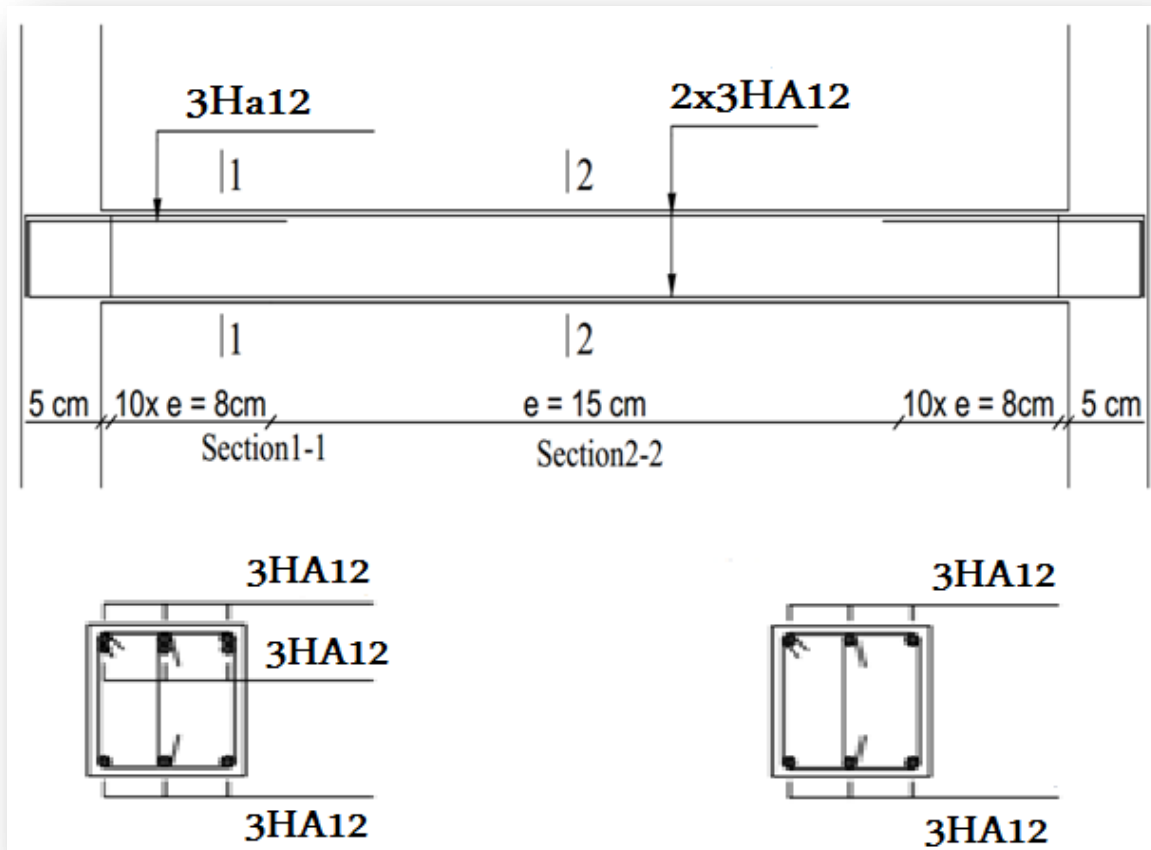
Schéma de ferrailage de la poutre palière
